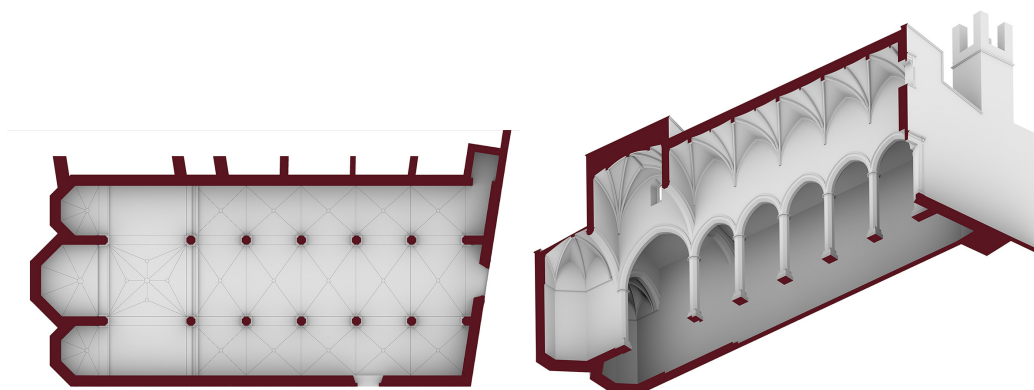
Pianta congetturale dell'ipotetico progetto di Antonio Belguardo.
